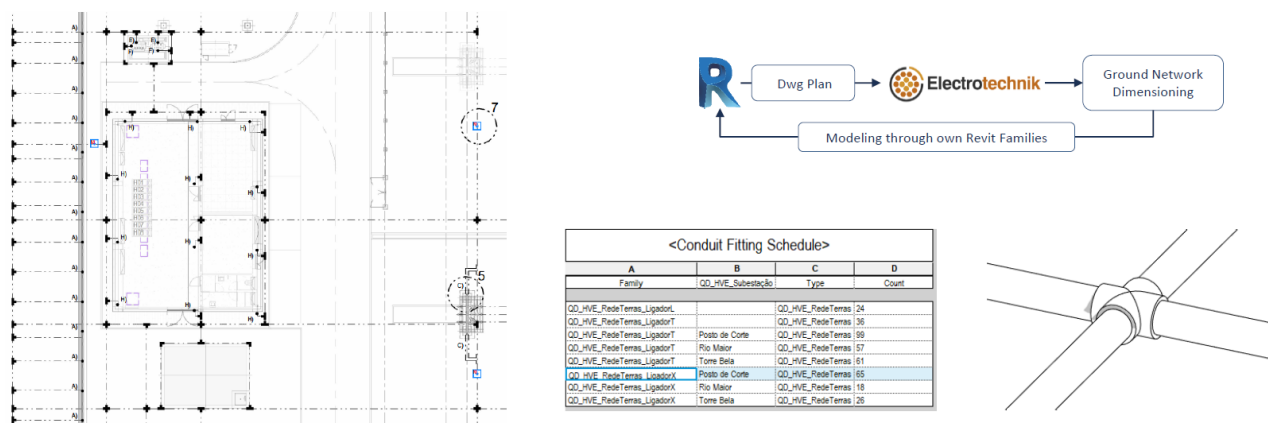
Integração Revit com Electrotechnik – Projetos de Subestações.
